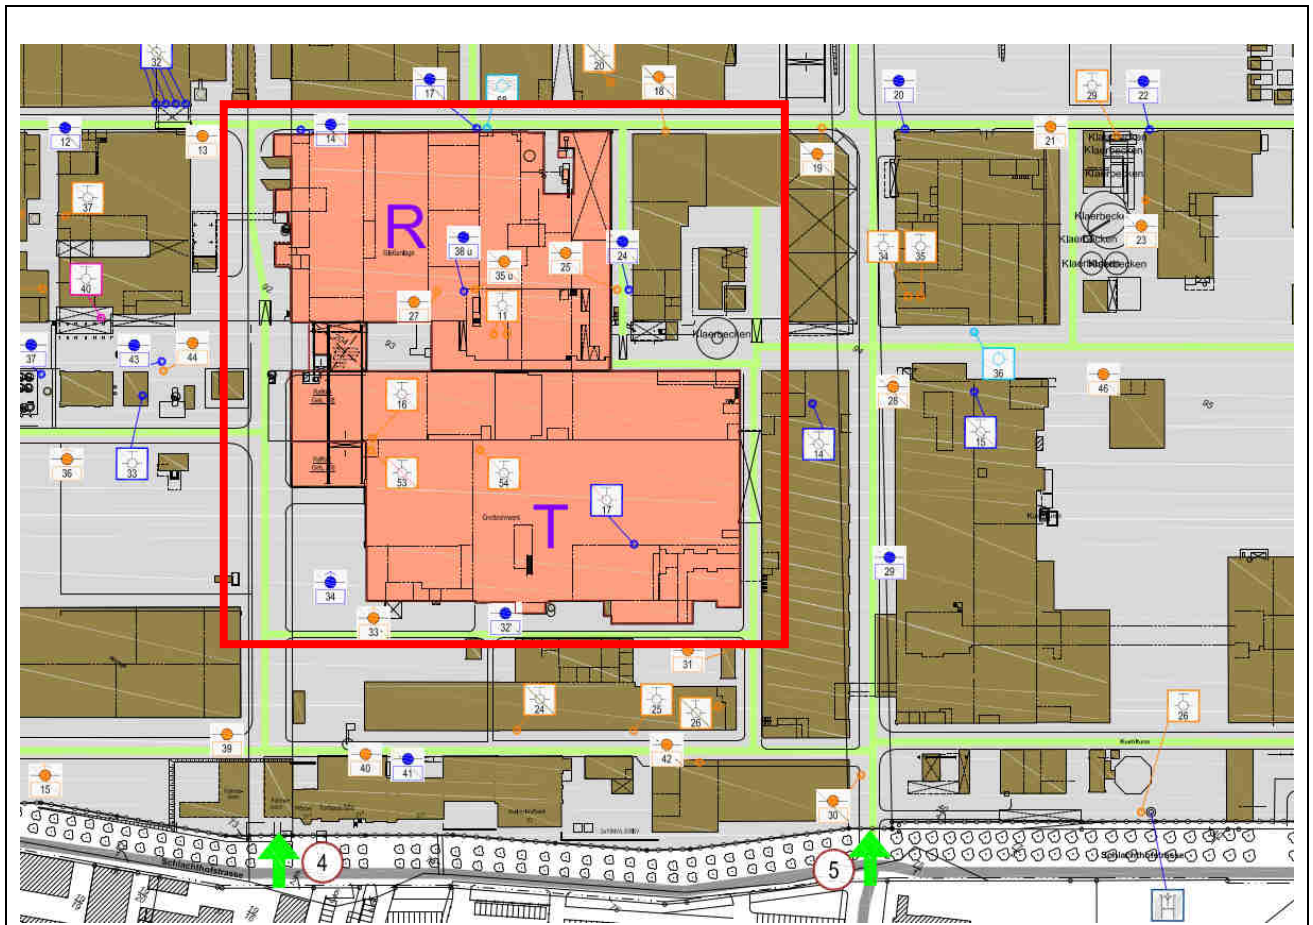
Planauszug zu Erreichbarkeiten, beurteilungsrelevantes Gebäude in roter Markierung
